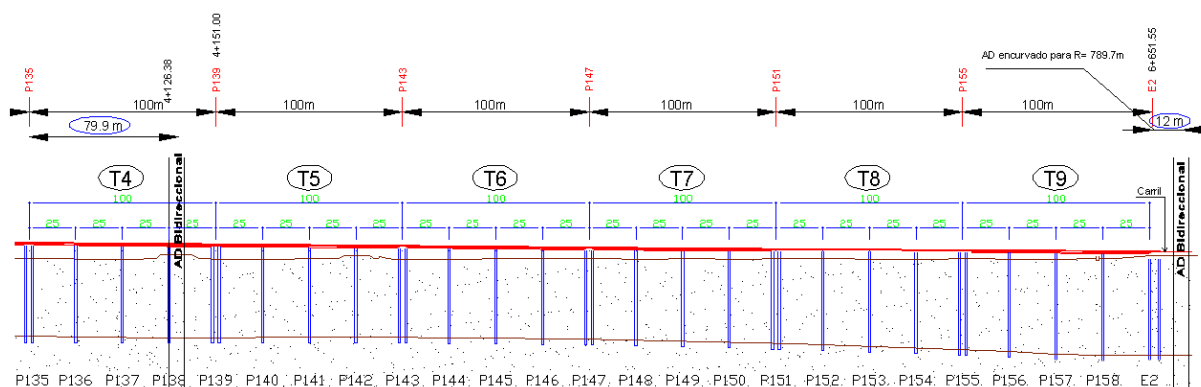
Corte longitudinal do trecho de via e viaduto em estudo (adaptado de REFER, 2005).
